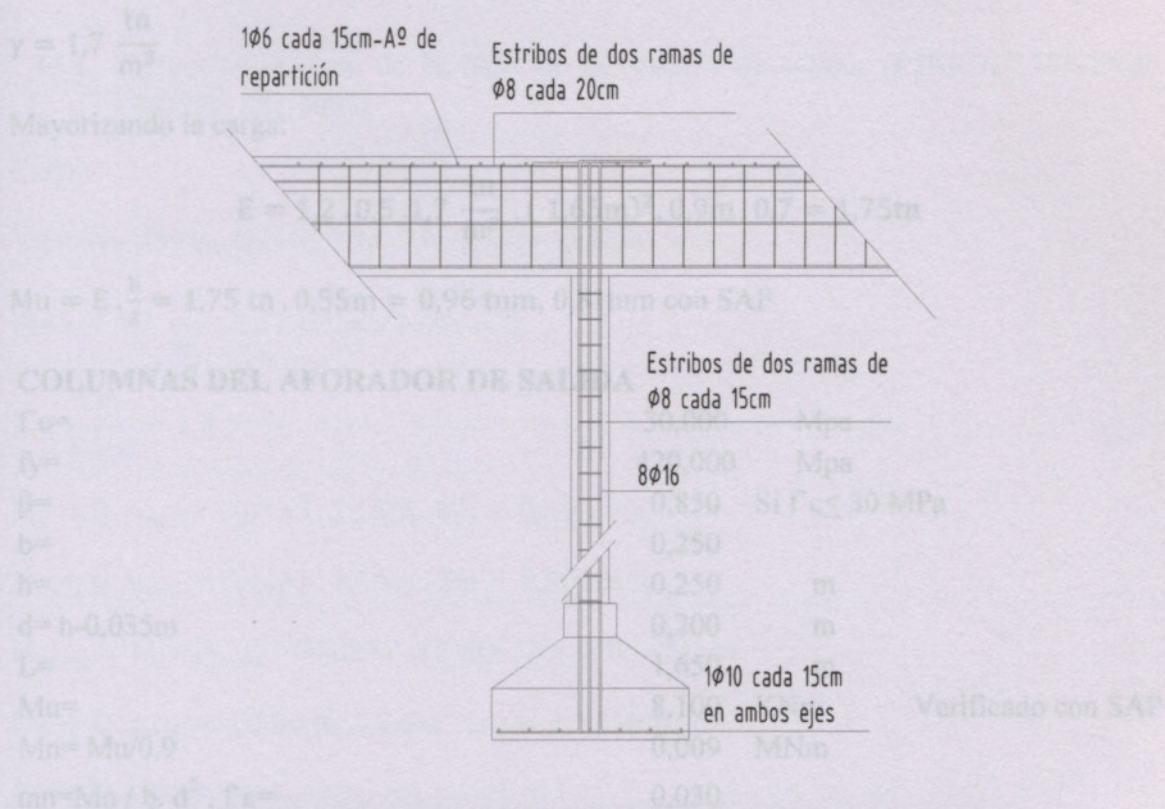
Representación de la armadura de la estructura de las pasarelas.
